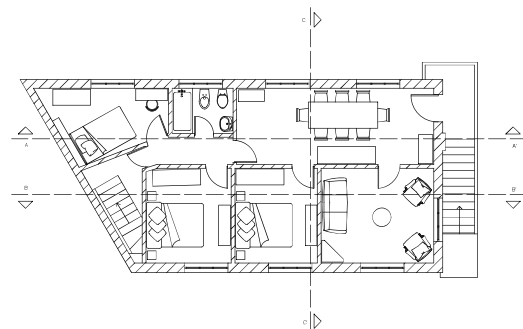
Planta Piso 1, atual. Fonte: Autor.
